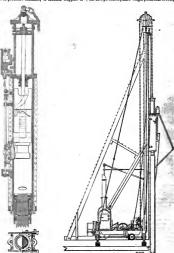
Coope do piston à vapeur la boite du mouton. (Echelle de 0,03.)
